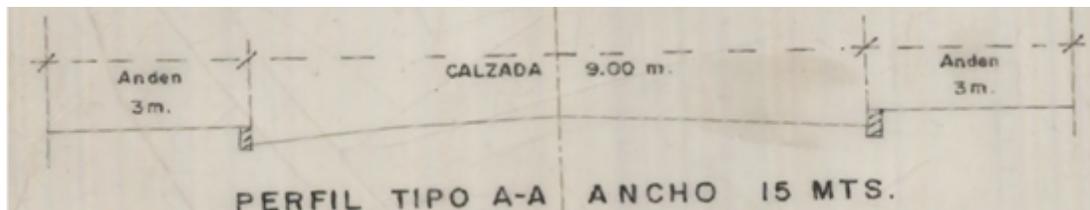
Perfil Carrera 41. Fuente: Plano urbanístico 114/4-5A y 114/4-5B
